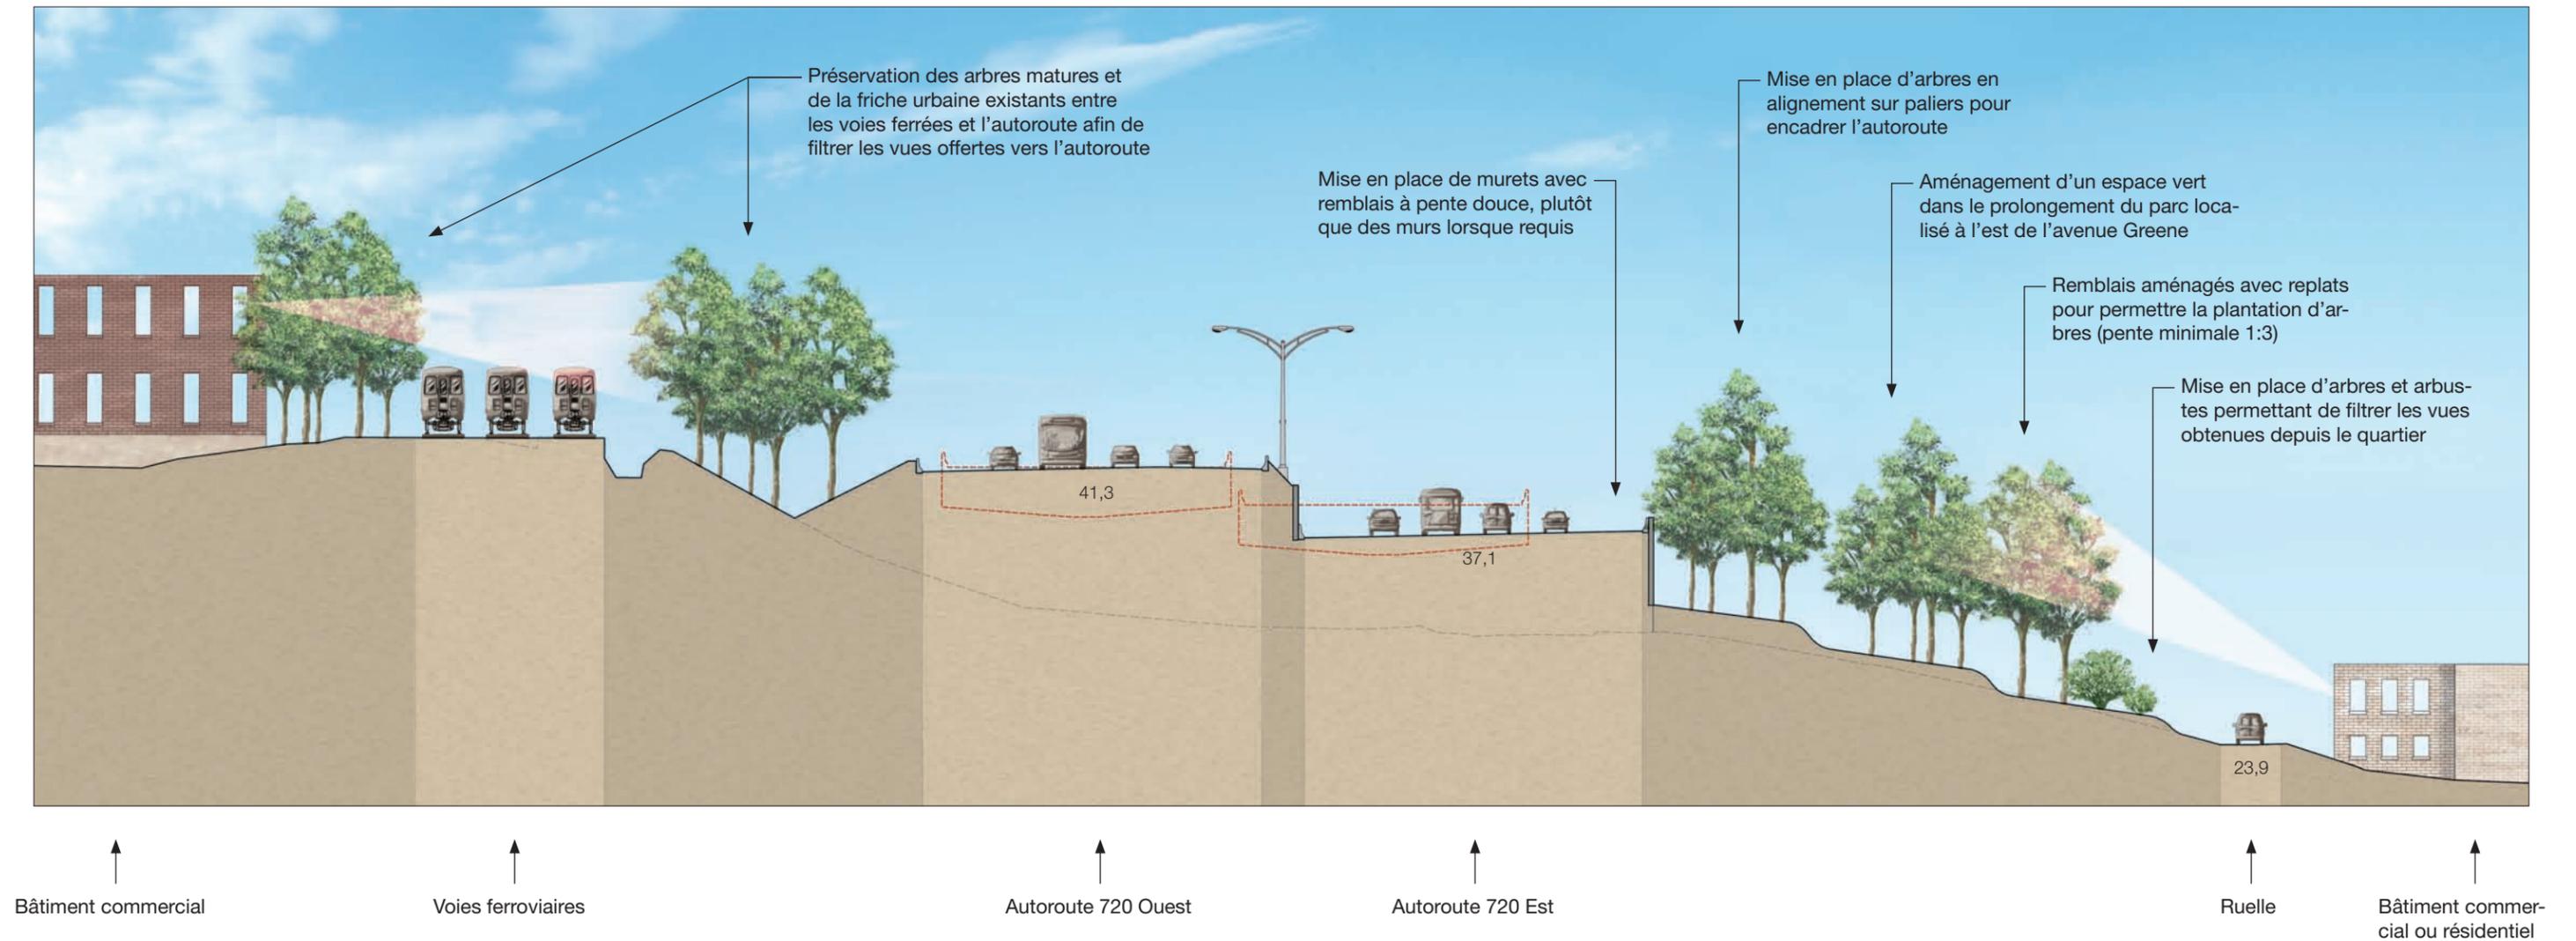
COUPE 6, AVENUE GREENE
